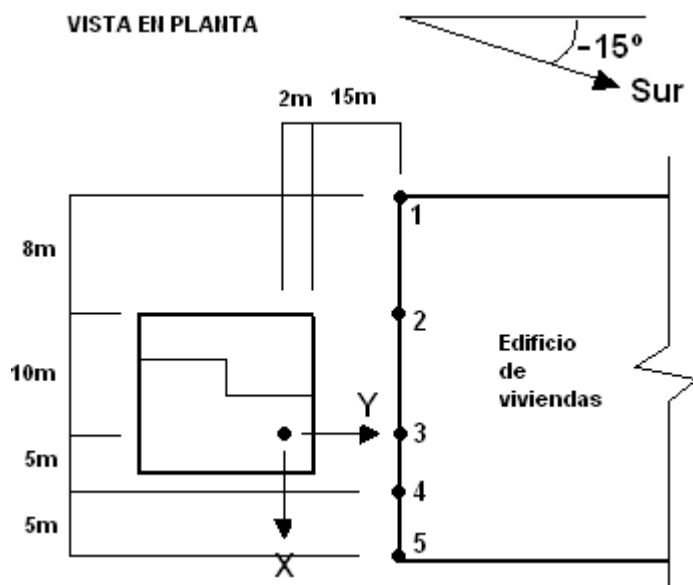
Vista en planta del restaurante y el edificio de viviendas.
